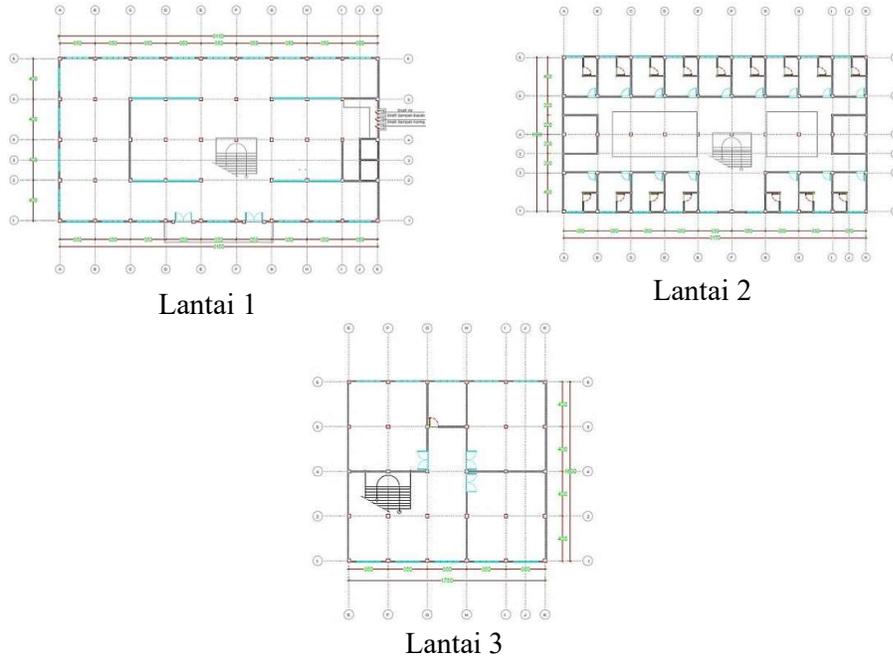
Denah lantai 1,2 dan 3 Bangunan Utama
